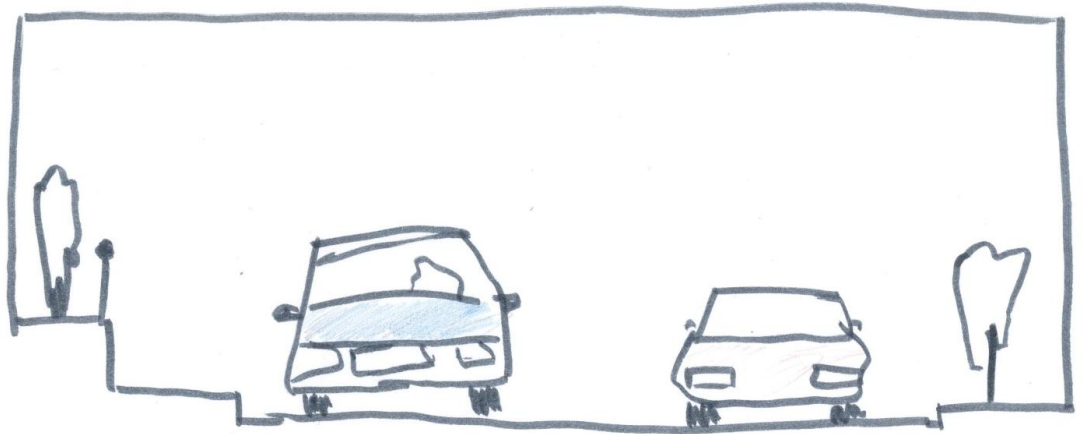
COUPE TRANSVERSALE DE LA ROUTE AU NIVEAU DU PASSAGE SOUS LA VOIE FERREE
